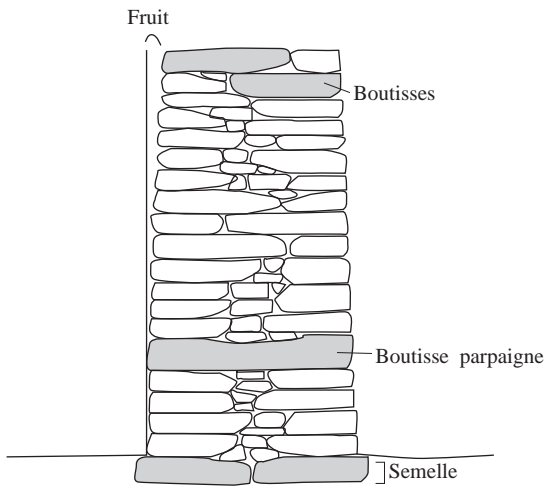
Coupe d'un mur en pierres sèches © d'après C. Lassure
